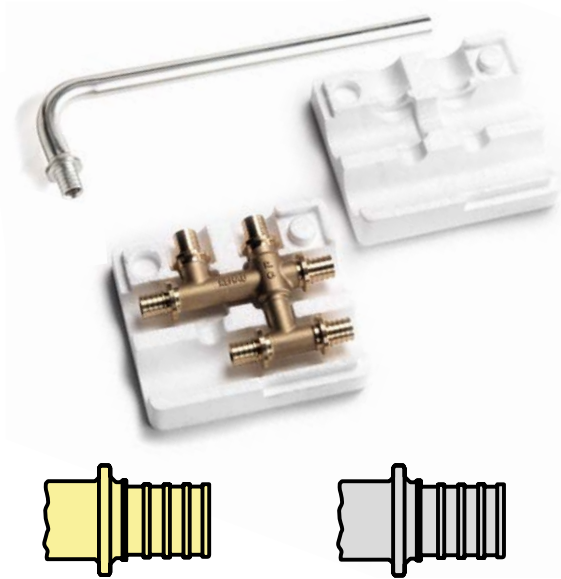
Fittings ausschließlich für die Heizungsinstallation
